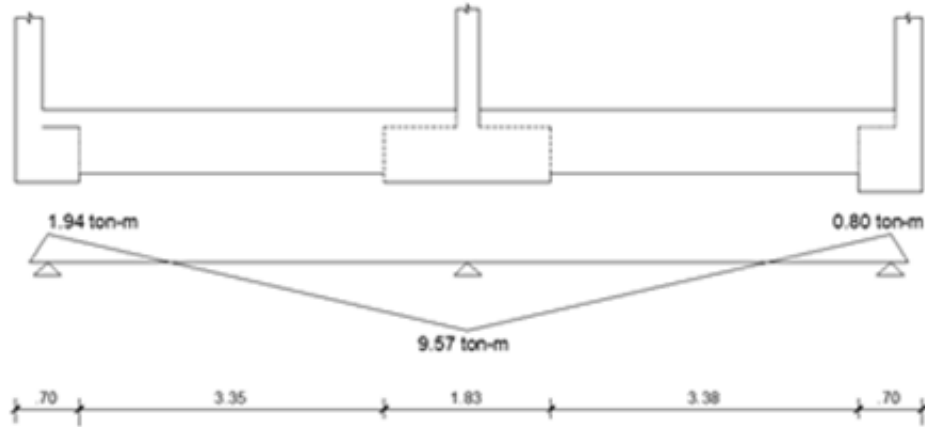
Elementos verticales a conectar mediante viga de cimentación
